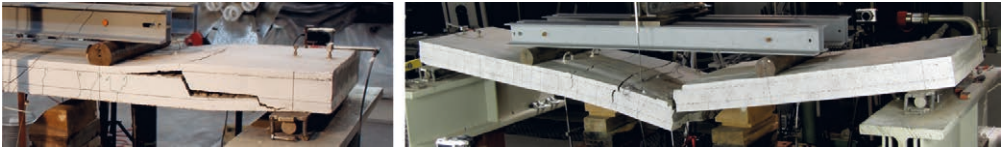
Geschichtete Platten aus Normal- und Porenleichtbeton (C20/25-PLB) mit Fugenversagen (links) bzw. Biegezugversagen (rechts) | Fig. 5: Layered slabs made of regular and foam concrete (C20/25-PLB) with interface failure (left) and bending failure (right)
